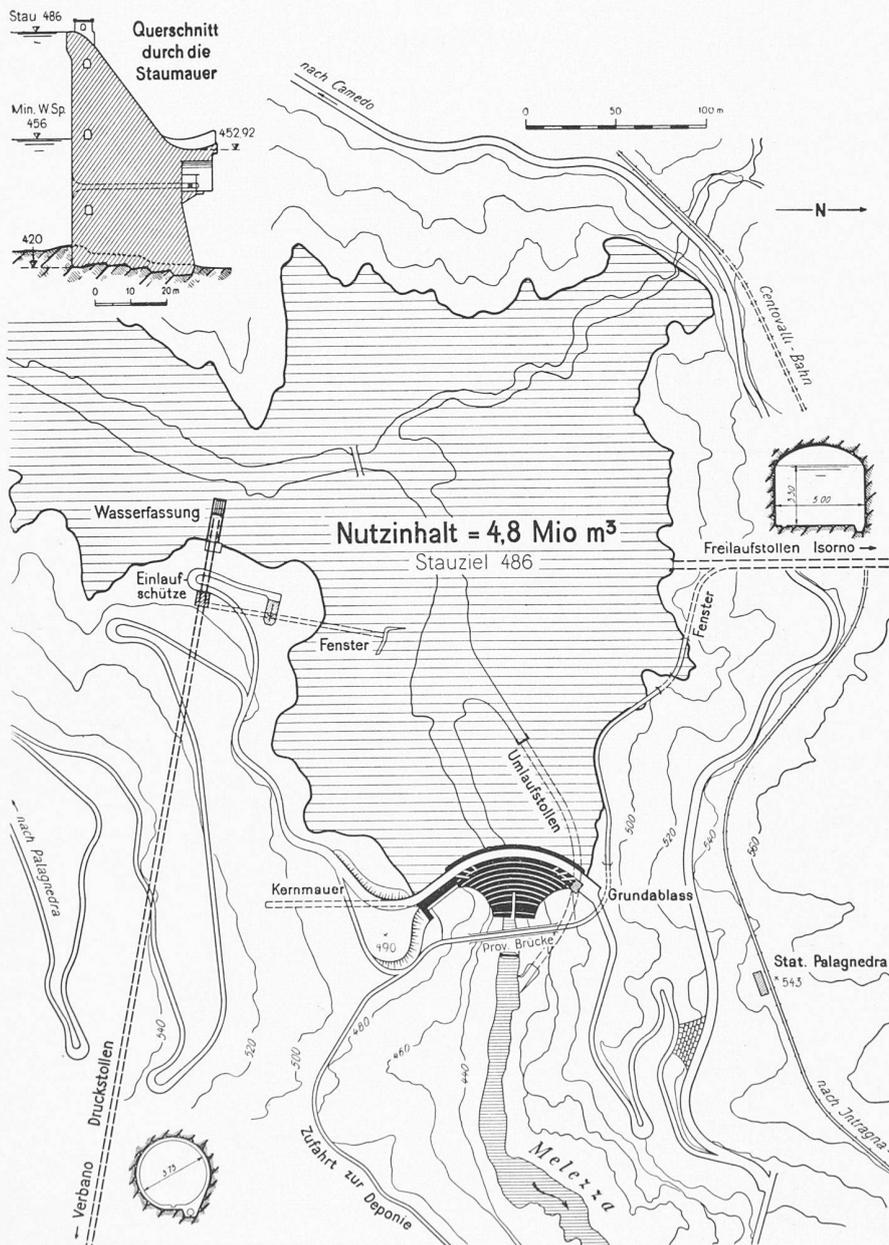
Staumauer und Ausgleichbecken Palagnedra, Lageplan rd. 1: 4000
